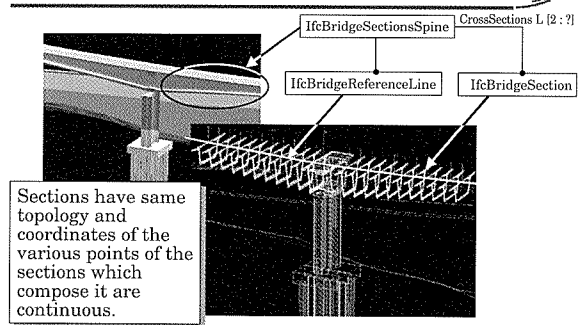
IFC BRIDGE における断面の表現方法⁶⁾
